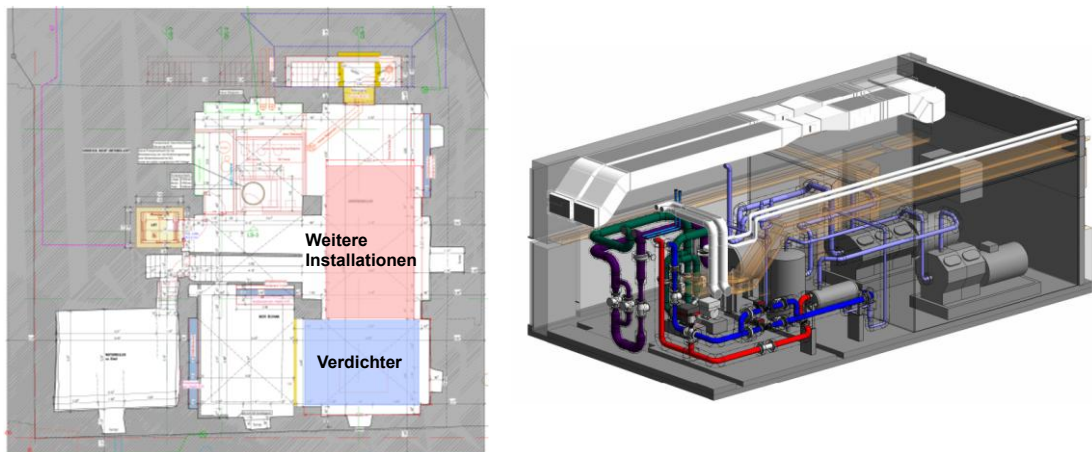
Mögliche Aufstellung der Grundwasserinstallationen im Gewölbekeller (links) und eine mögliche Ausgestaltung der Lärmschutzmassnahmen (rechts) mit Einhausung der Wärmepumpenanlage
